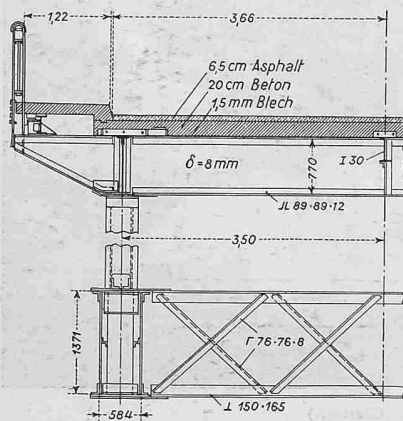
Querschnitt durch Fahrbahn und Bogenkonstruktion; 1:100
